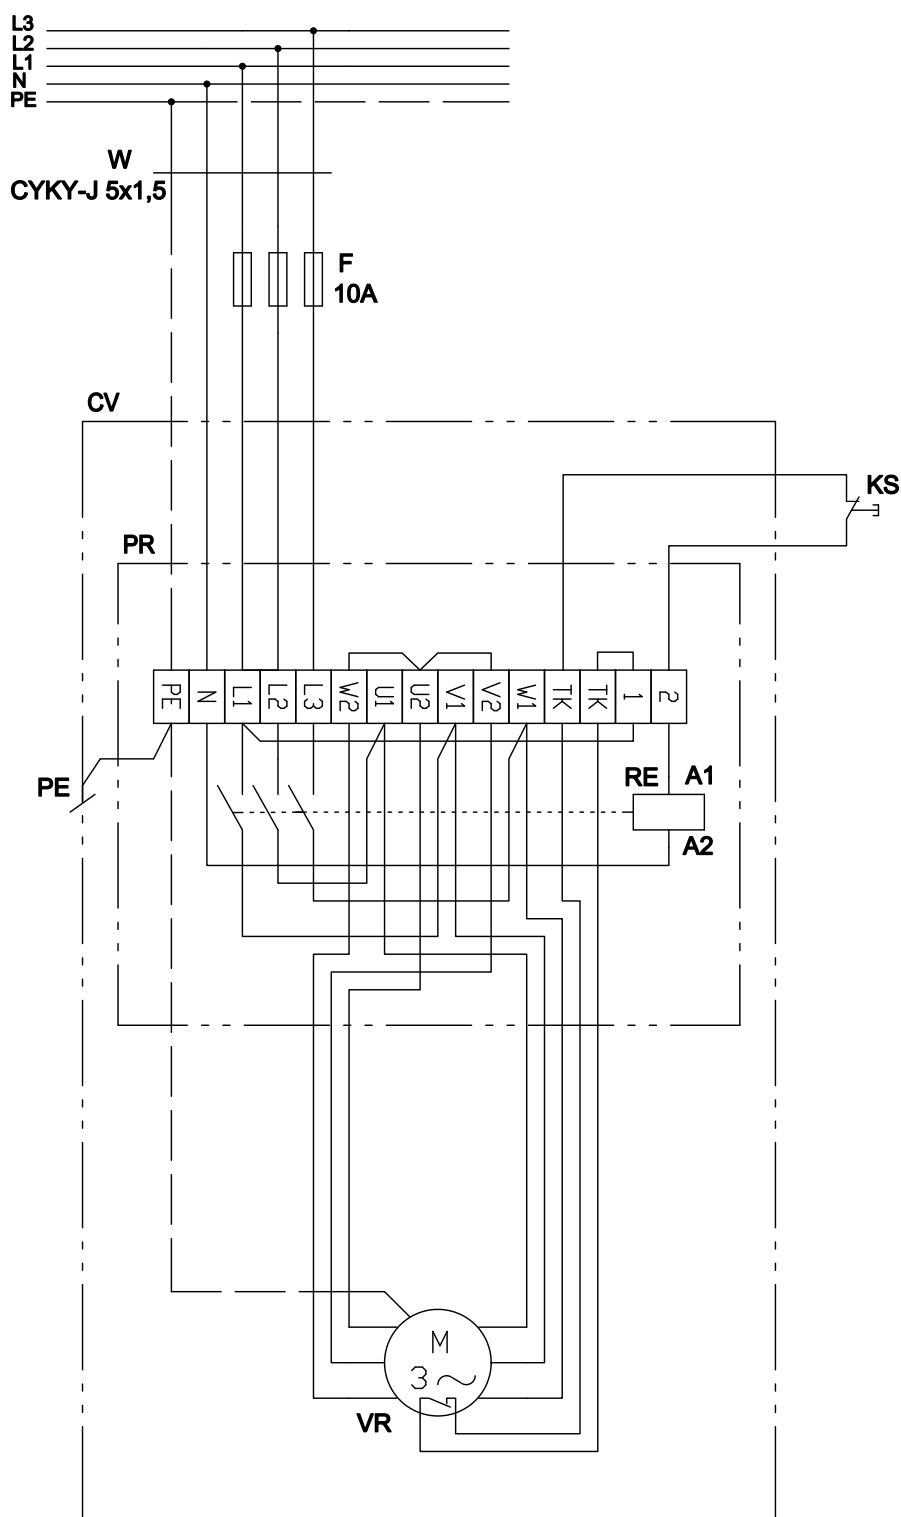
Schéma pro vratovou clonu se třífázovým motorem ventilátoru, zapojení do trojúhelníku
